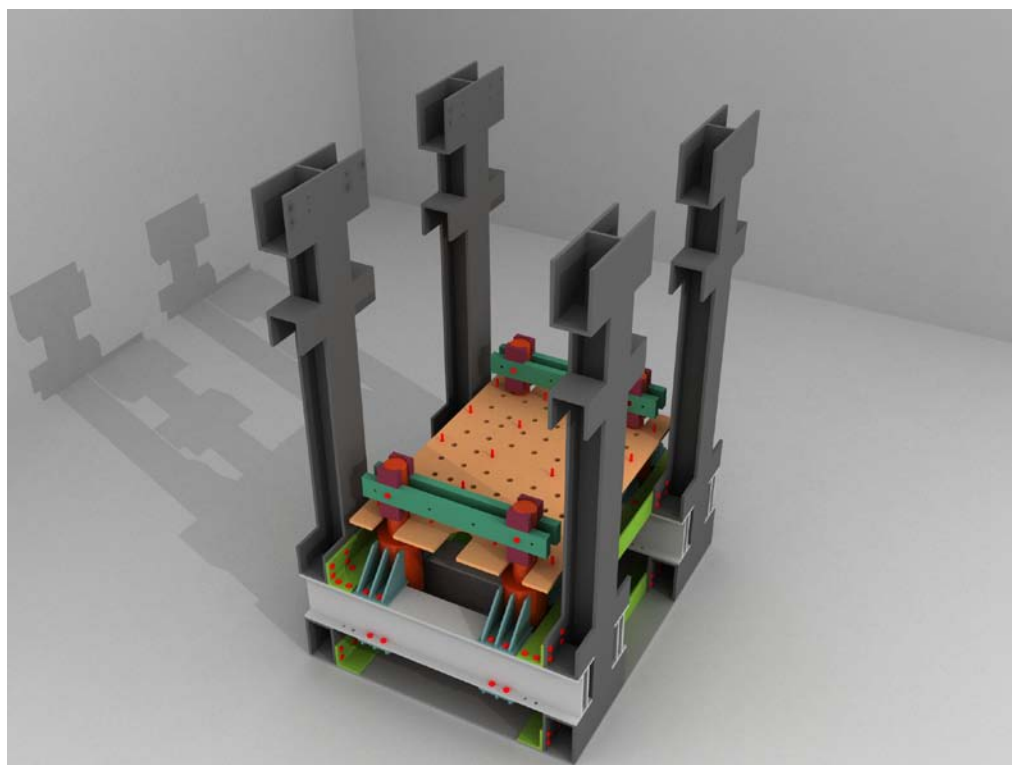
Montaj model instalație IIECON . Etapa 8. Bare prindere pistoane cilindri.
